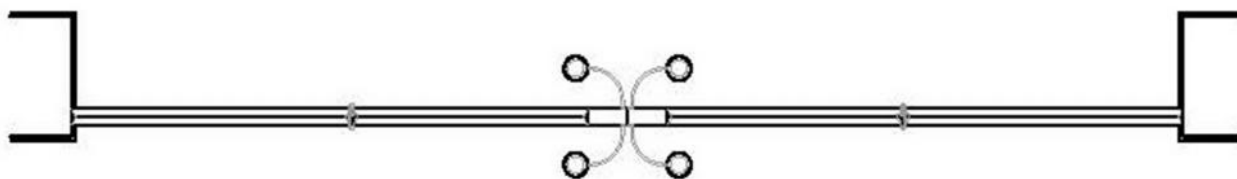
Puerta lateral a pérgola. Alzado y planta
